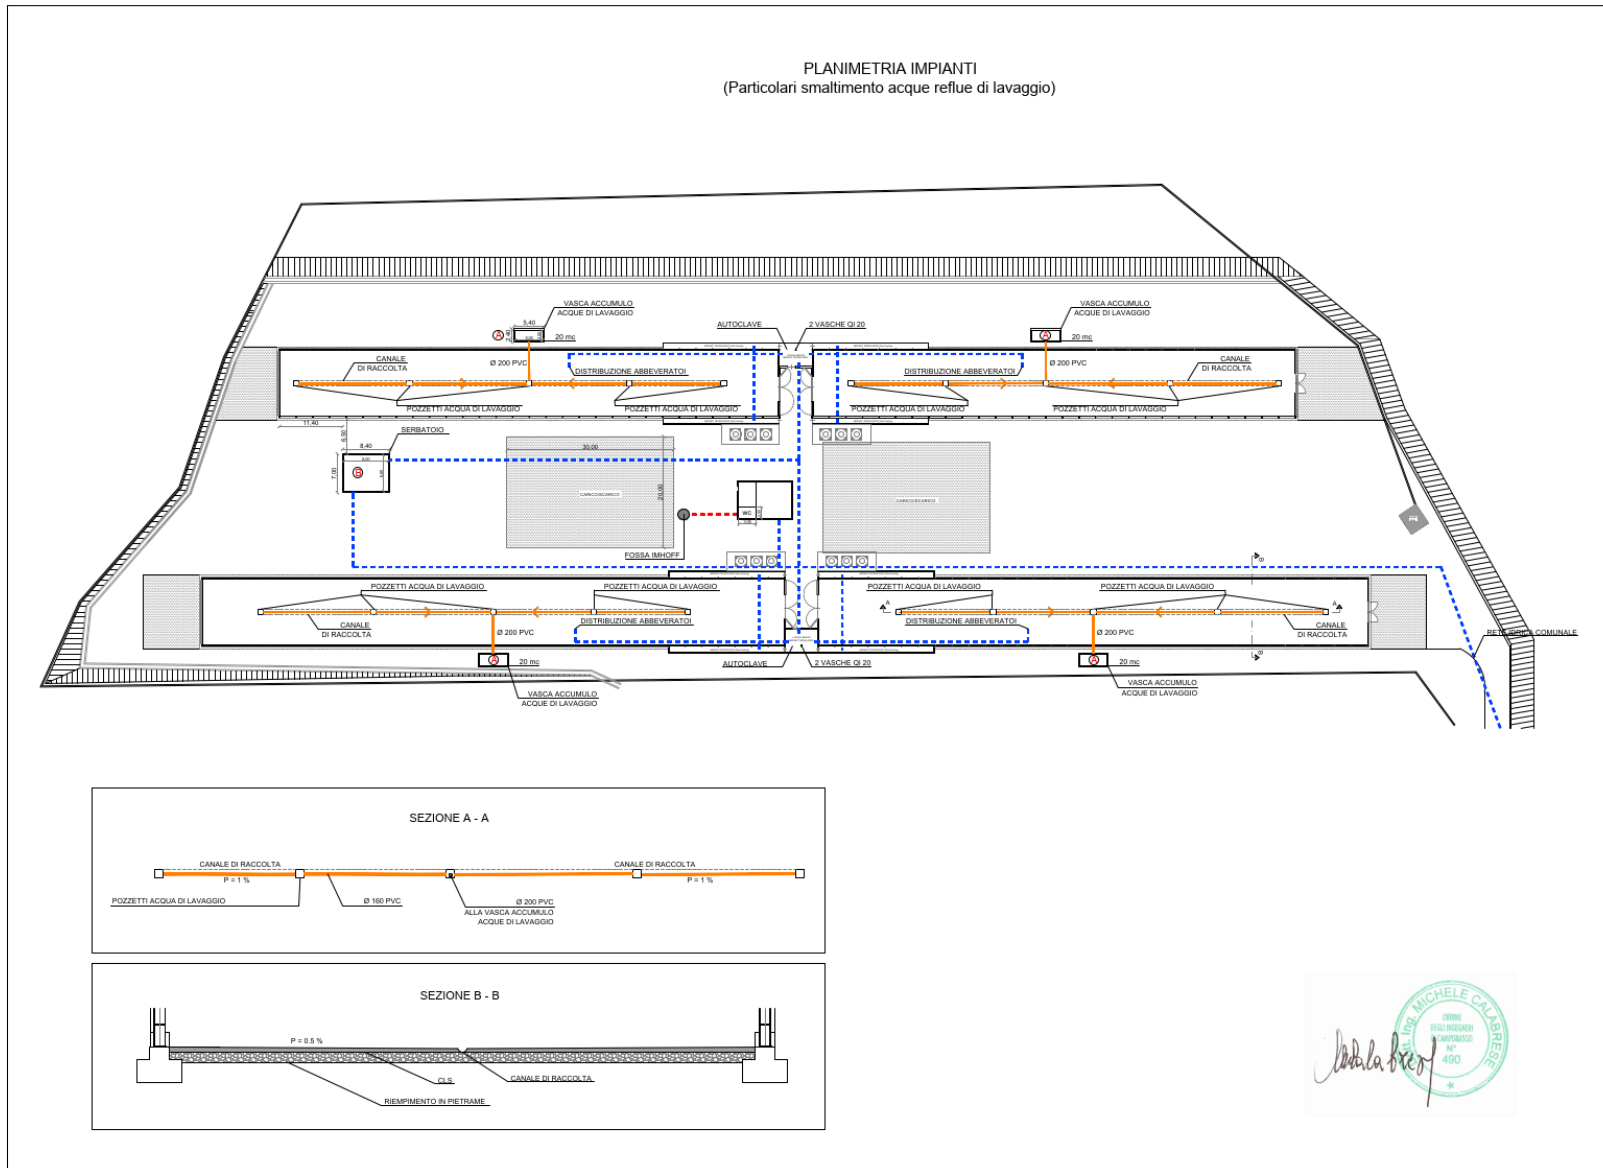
planimetria generale di stabilimento con indicazione dell'impianto di lavaggio dei capannoni
